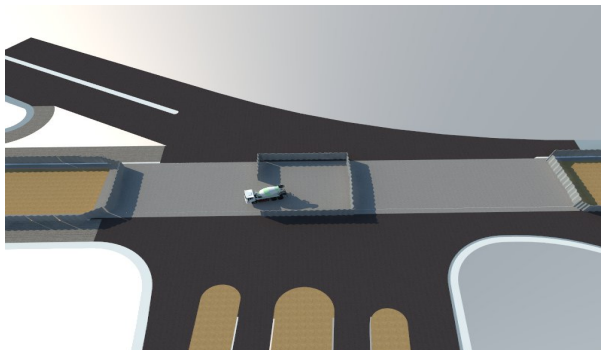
Site plan pekerjaan top slab tahap 1
